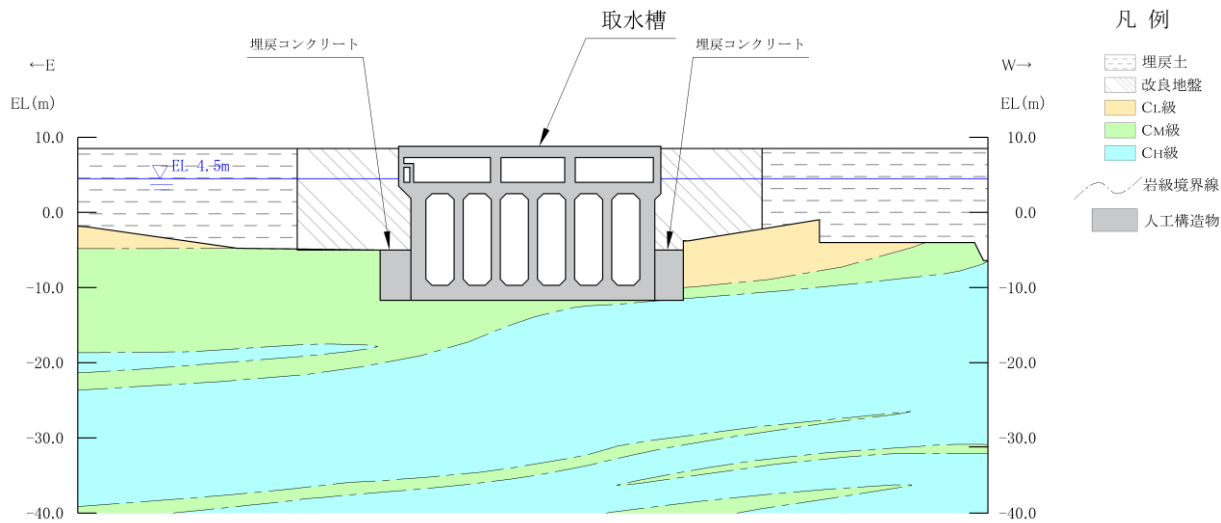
取水槽 地震時荷重算出用地質断面図 (A-A 断面)
